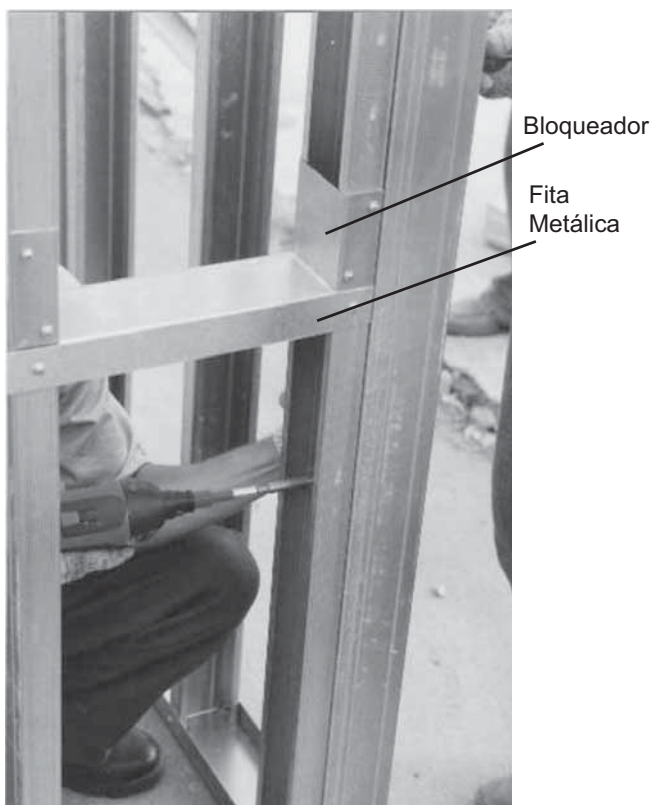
Bloqueador e fita de aço galvanizado fixados ao painel para travamento horizontal (Fonte:arquivo do autor)
